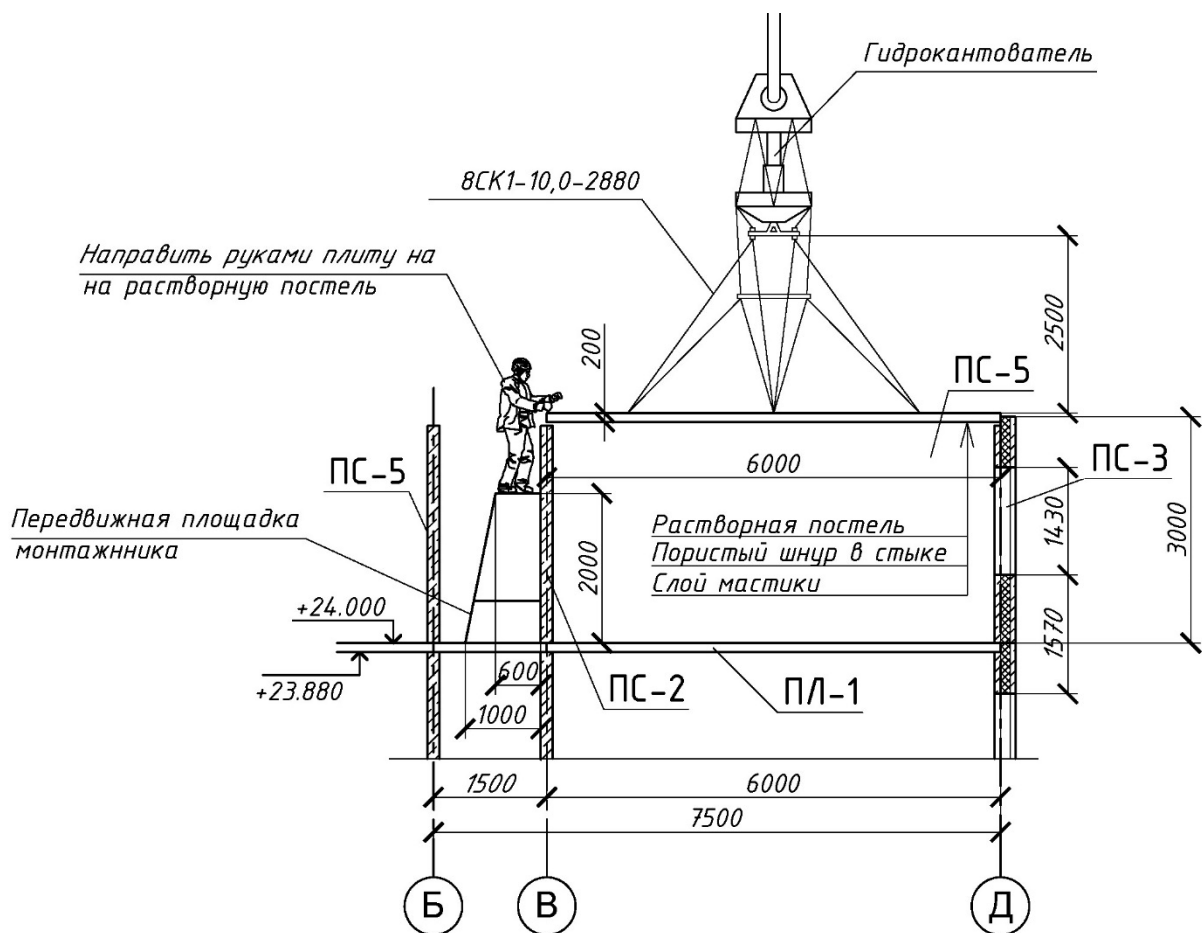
Схема монтажа плит перекрытия в разрезе.
